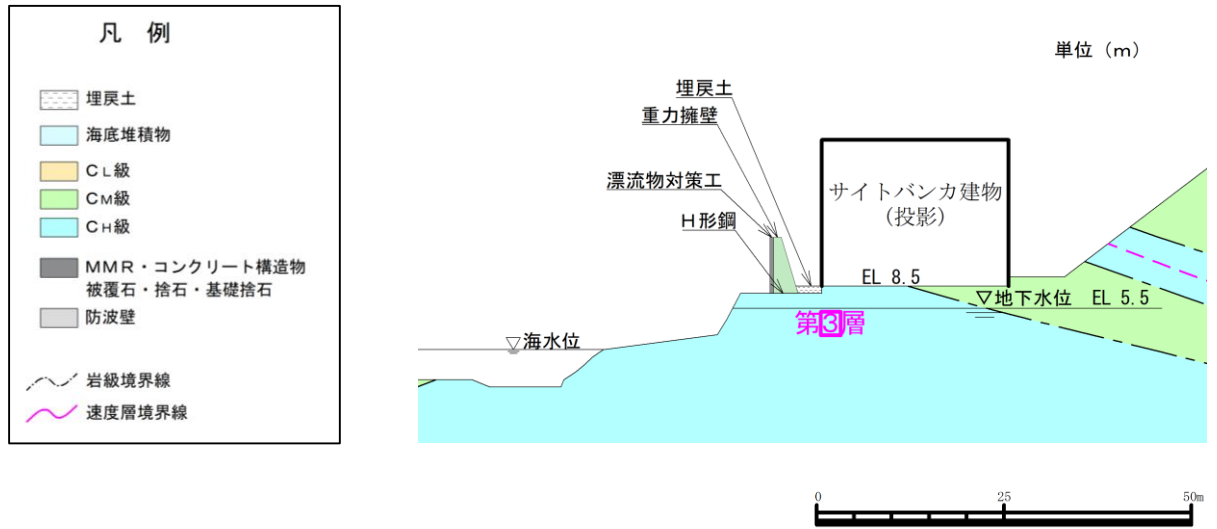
防波壁（波返重力擁壁）の横断面図（⑤-⑤断面）
